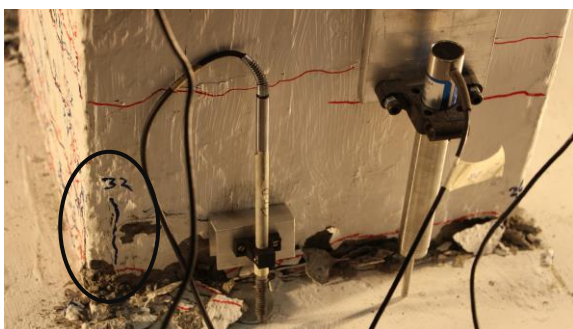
Fissures verticales de compression sur la face latérale droite de la colonne C1A au LS32
